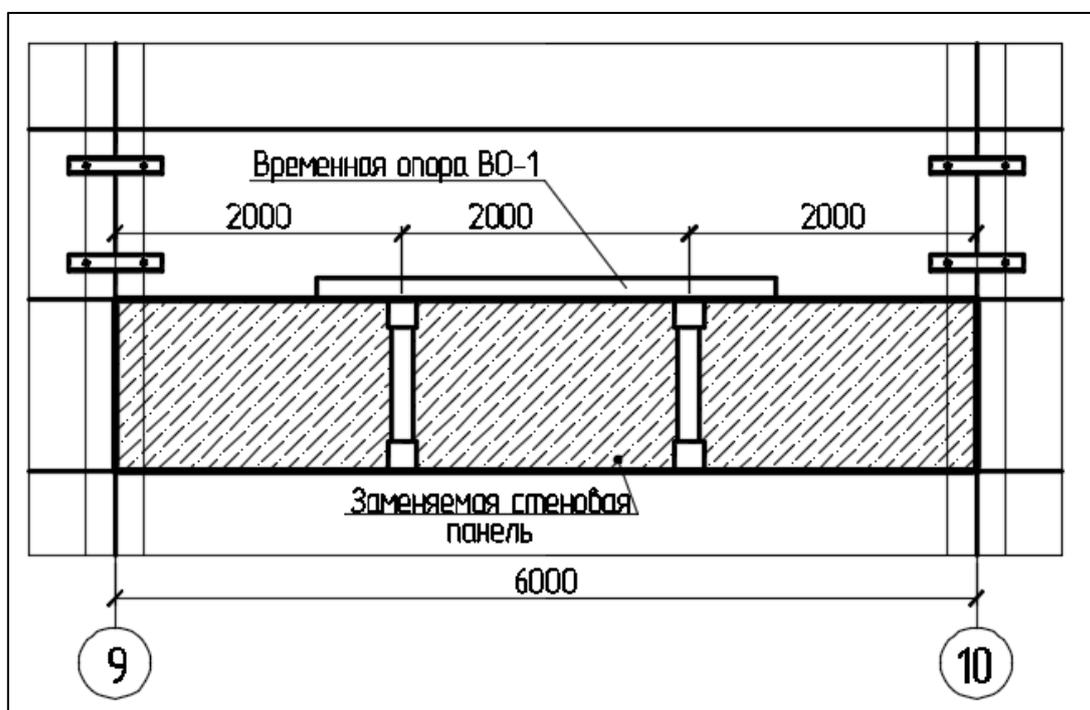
Конструкция временных опор под верхнюю стеновую панель
